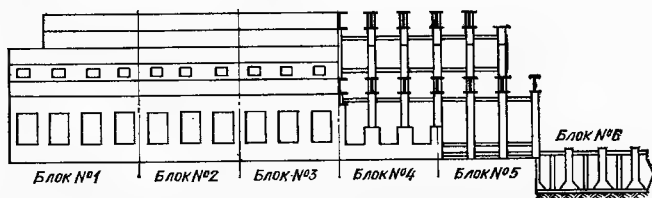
Поточно-совмещенное строительство главного корпуса: блок № 1 — эксплуатация; блок № 2 — наладка; блок № 3 — монтаж оборудования; блок № 4 — монтаж стеновых панелей; блок № 5 — монтаж каркаса; блок № 6 — завершен монтаж подземного хозяйства
